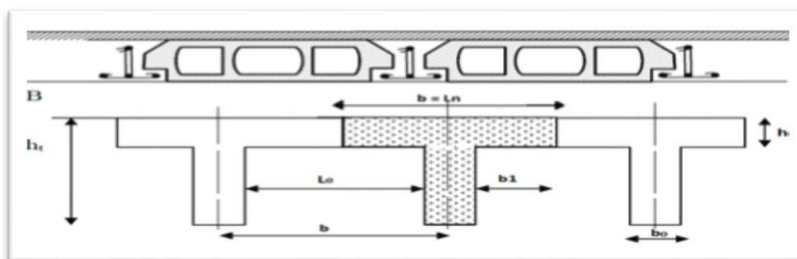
Coupe transversale d'un plancher à corps creux
